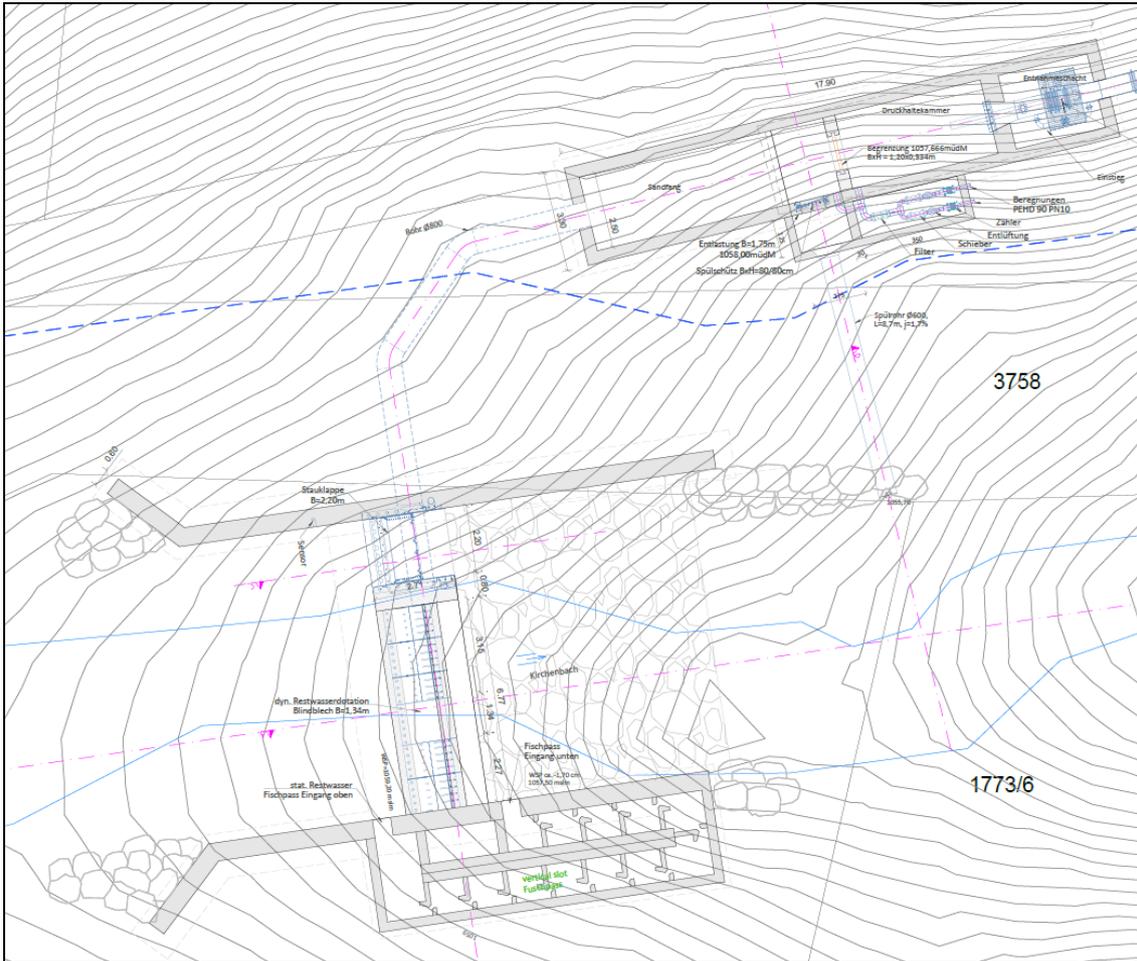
Planimetria di progetto: opera di presa e dissabbiatore (fonte: Tavole progettuali)
